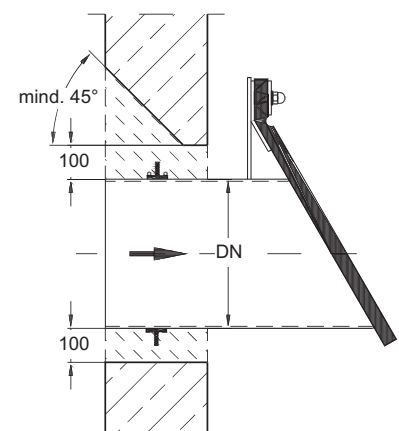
Ausparung für das nachträgliche Einbetonieren von Rückstauklappen des Typs RM
